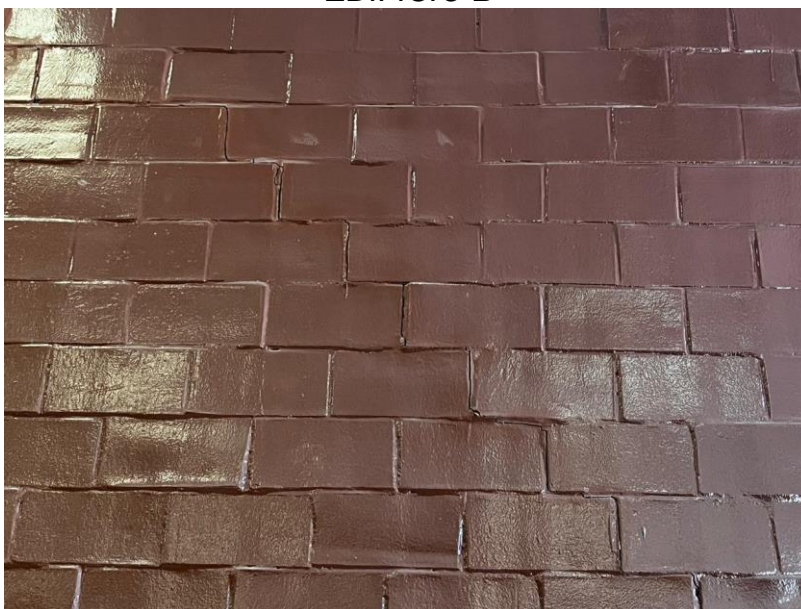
Edificio B. Fisura en muro divisorio de tabique vidriado, cara poniente, 2º nivel.
